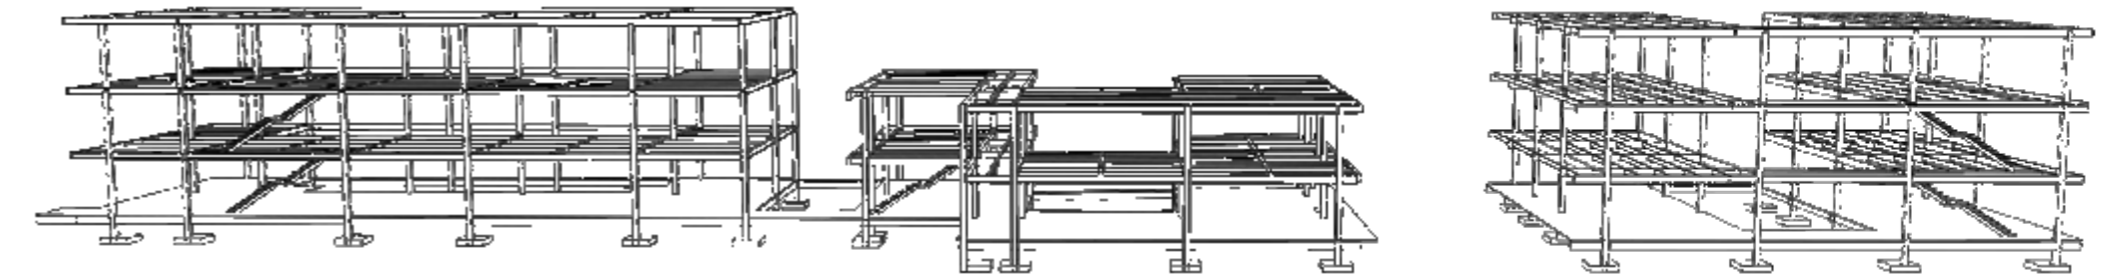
Diagrama de perspectiva de estructura del proyecto alta
